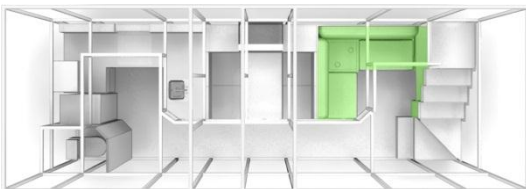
Planta inferior del Habita-Mueble (Sala).
